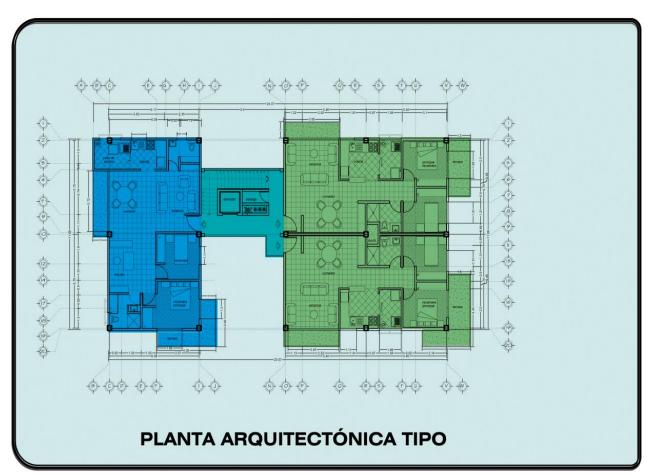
PLANTA ARQUITECTÓNICA TIPO
